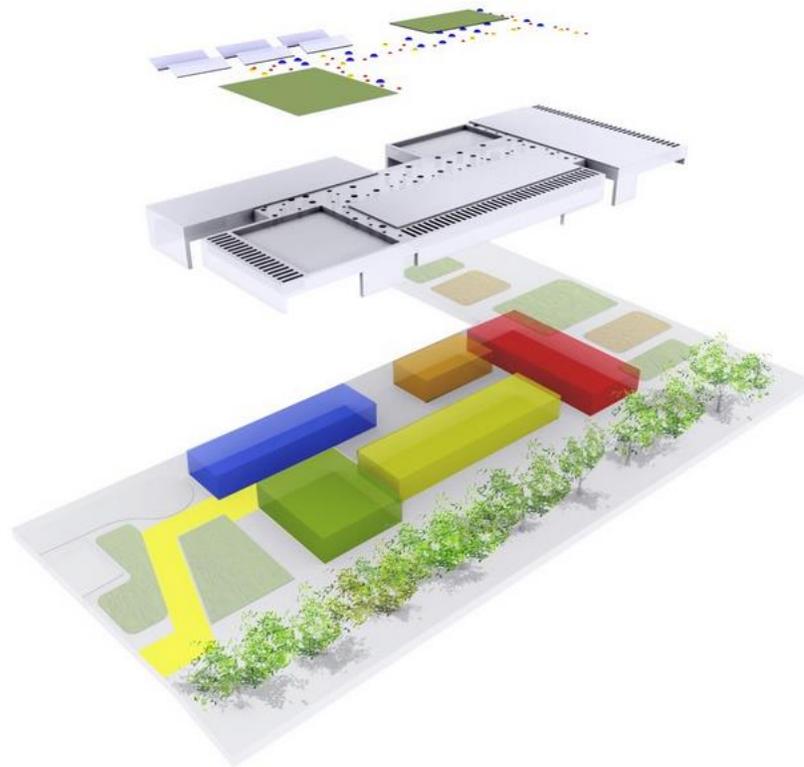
Planta explotada. Fuente ArchDaily [www.archdaily.mx](http://www.archdaily.mx)
